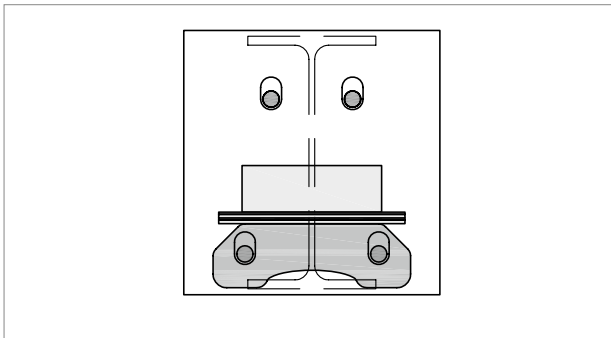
Schöck Isokorb® : liaison acier – béton armé ; des plaquettes d'écartement à placer sur la plaque de reprise de charge permettent de réhausser la poutre en acier de maximum 20 mm
